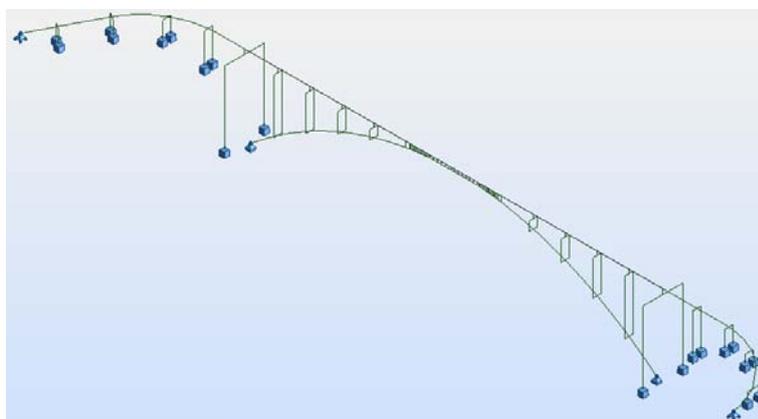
Vista tridimensional do modelo de cálculo global da estrutura projectada
